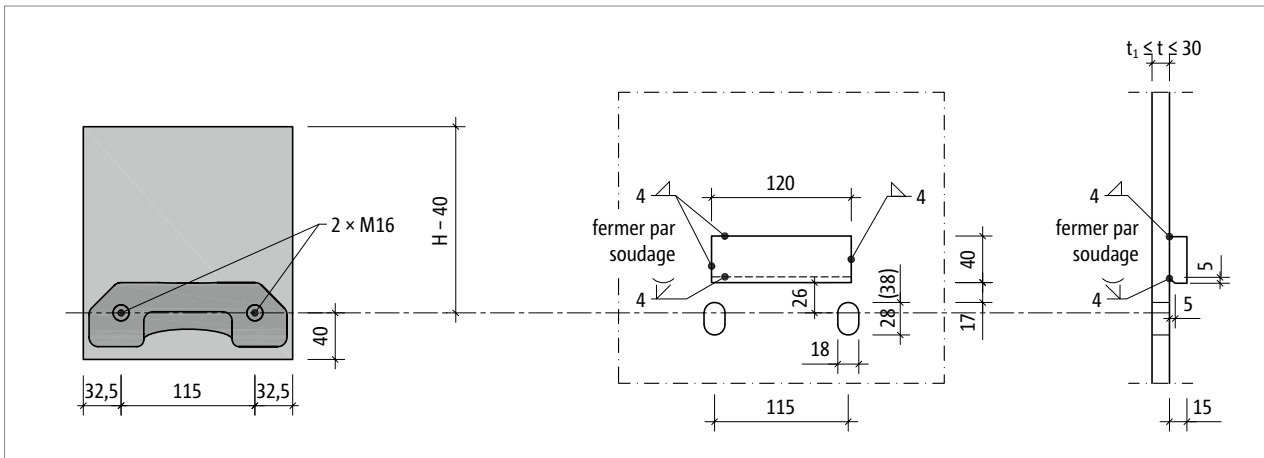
Schöck Isokorb® T type SQ : construction du raccordement de la plaque frontale
